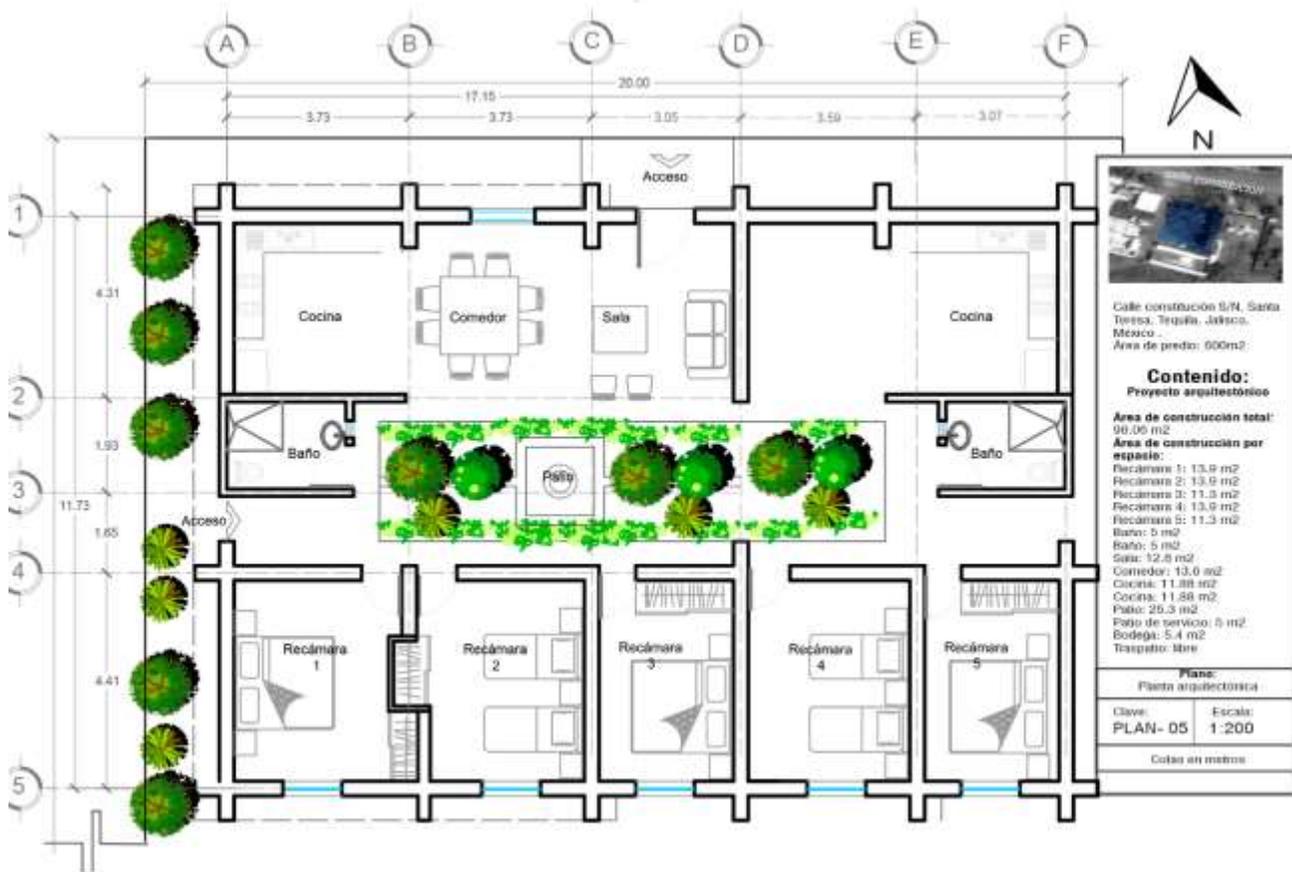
Planta arquitectónica de vivienda para la familia ampliada. Fuente: Autor.
